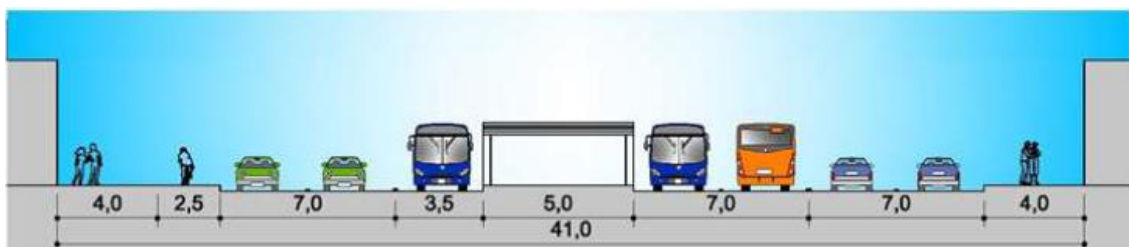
SEÇÃO TRANSVERSAL PREVISTA
